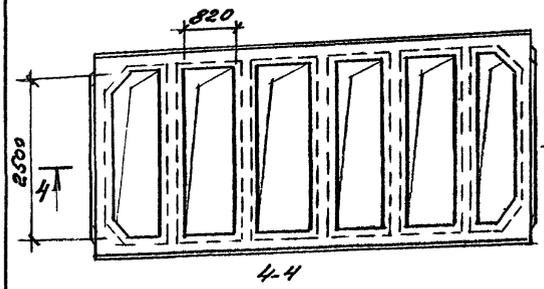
ПЛИТА ДЛЯ ЛЕГКОСБРАСЫВАЕМОЙ КРОВЛИ
